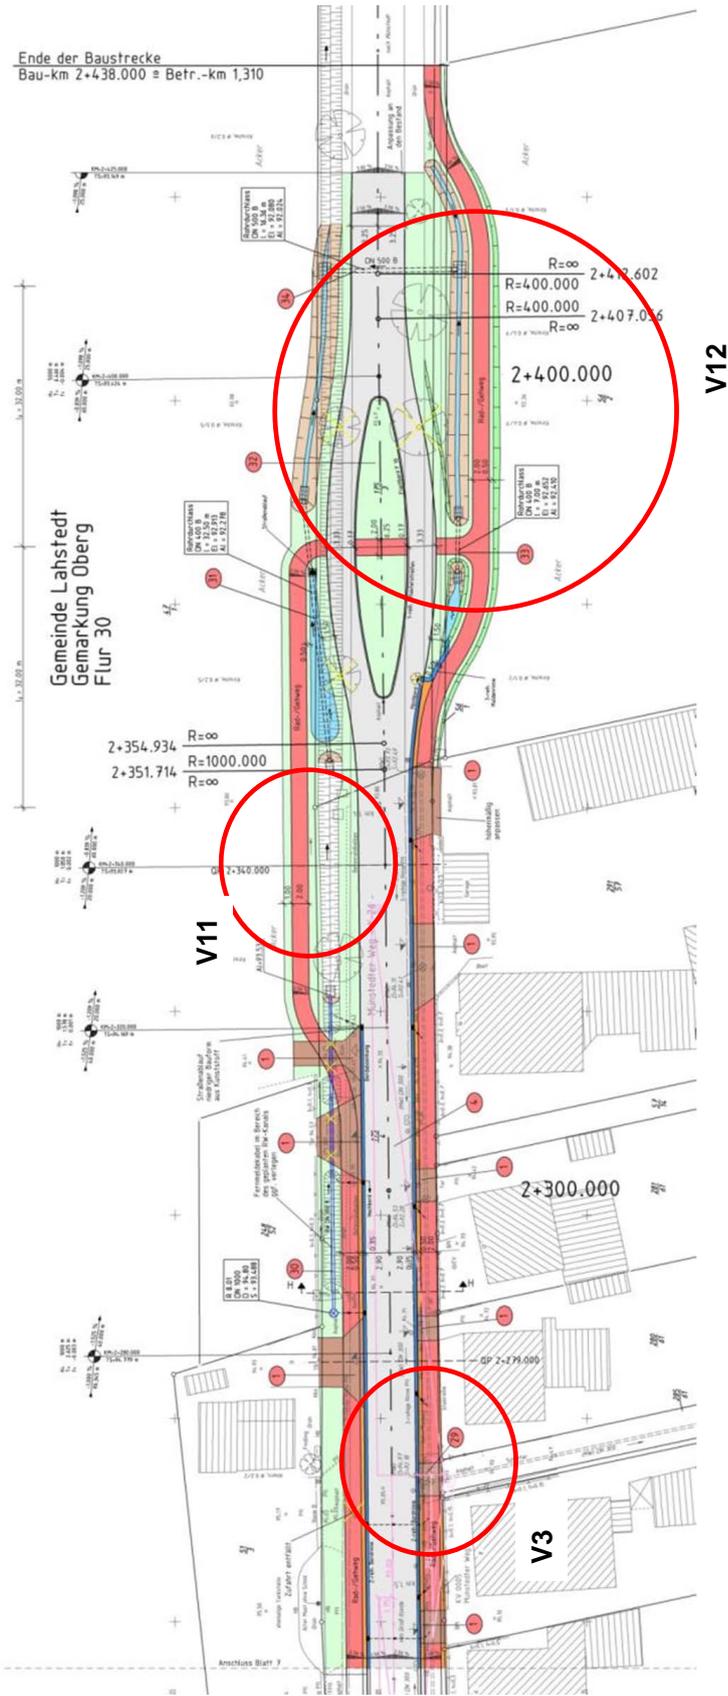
Umgestaltungsvorschläge zur Ortsdurchfahrt Oberg - Lageplan Blatt 6
